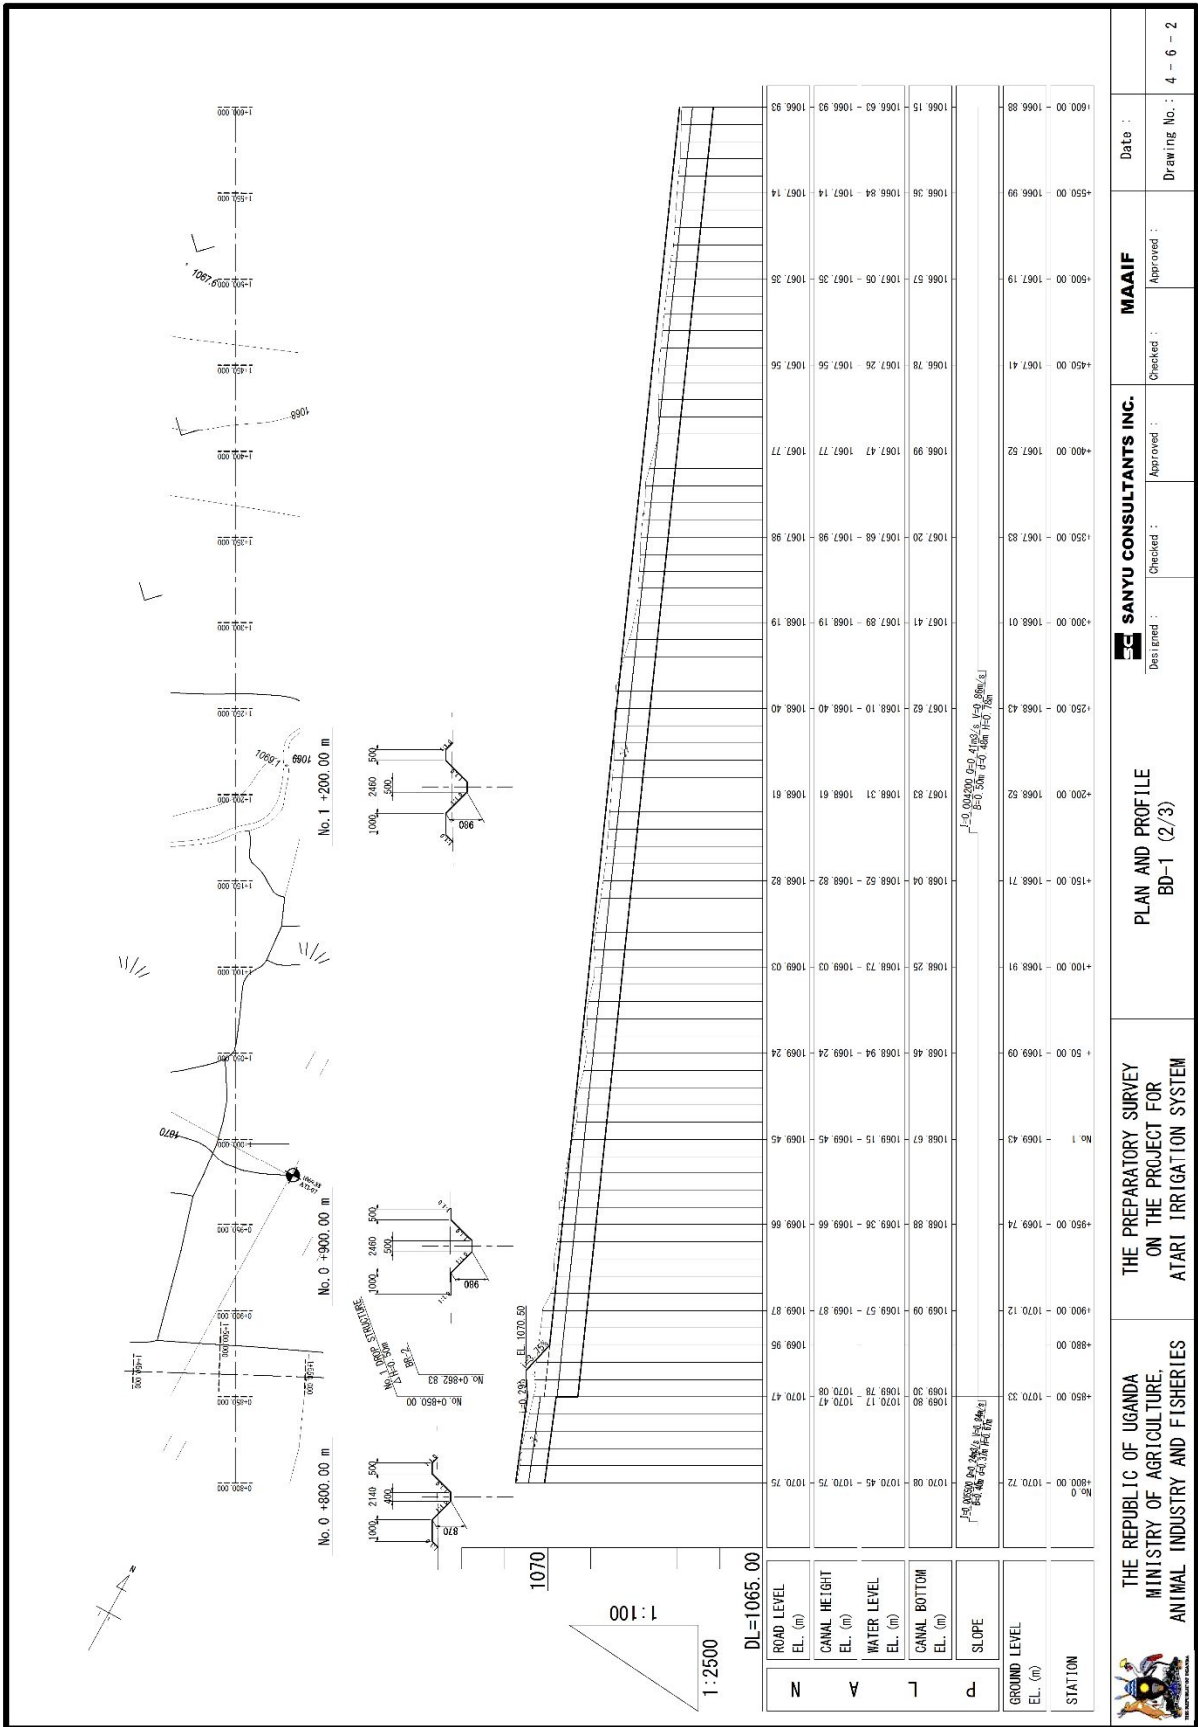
ブランブリ県排水路(BD-1)縦断面図 (2/3)
